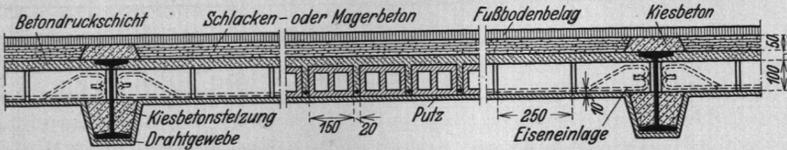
Steineisendecke aus Kleineschen Deckensteinen.
